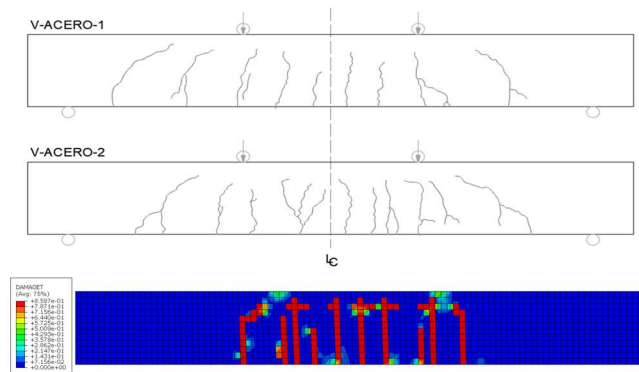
Agrietamiento de la viga reforzada únicamente con acero obtenido mediante modelación en ABAQUS
